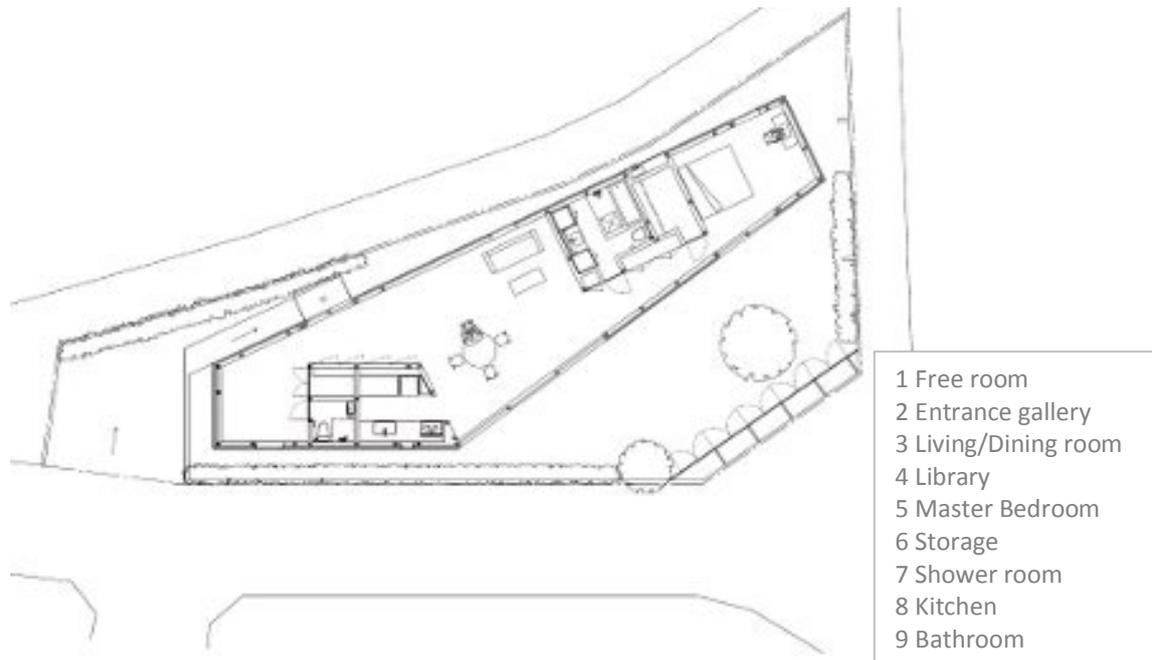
TSUI NO SUMIKA House, Grundriss, Quelle: [www.kite-architecture.jp](http://www.kite-architecture.jp)
